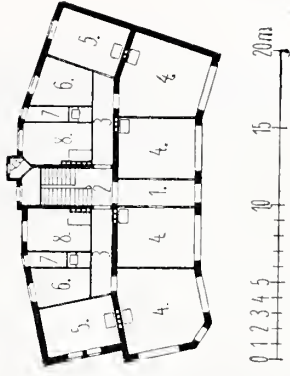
und 582. Grundrisse zu Abb. 578. Architekt: L. RINKEL in Berlin.
